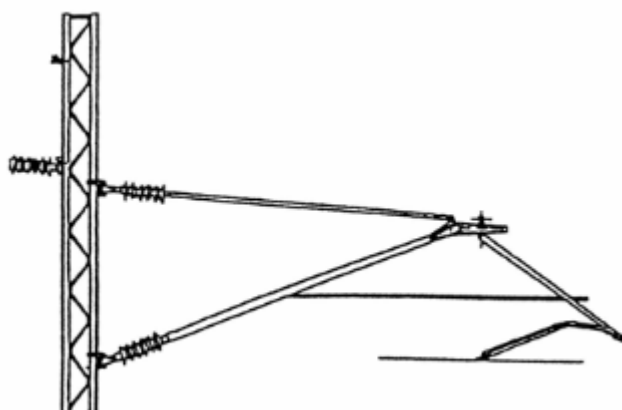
Particolare della sospensione a puntone inclinato in lega d'alluminio.
